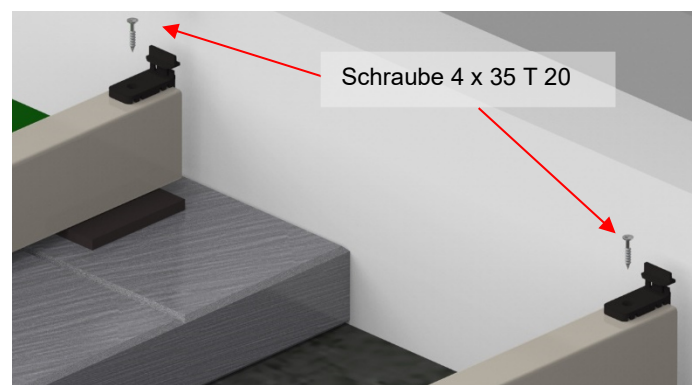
Der Startclip wird mit den Schrauben 4 x 35 mm (T 20) auf die Holzunterkonstruktion geschraubt. Bei Verwendung einer Aluminium-Unterkonstruktion muss die Schraube 4,2 x 19 mm (T 20) verwendet werden.
